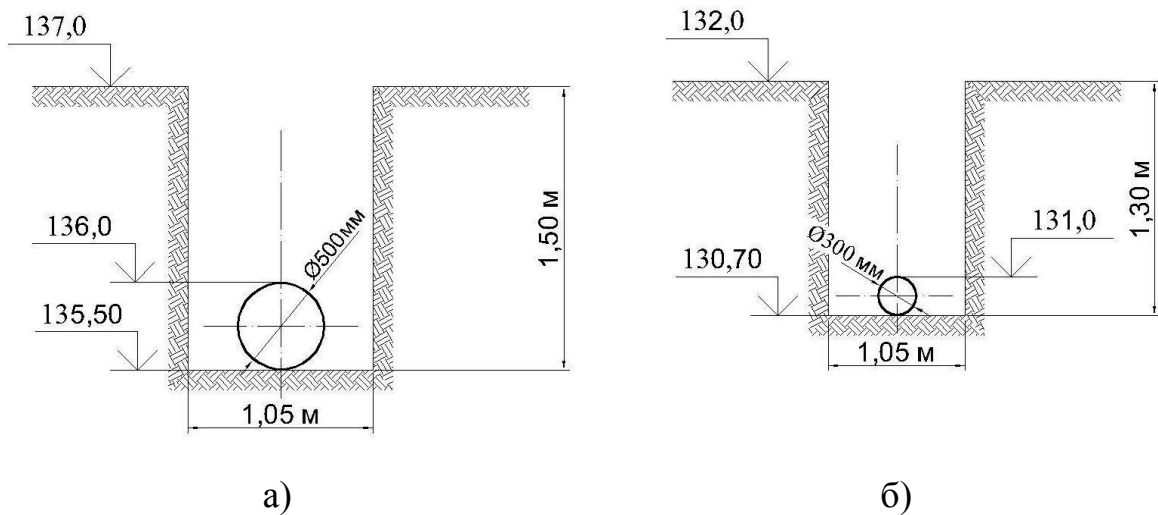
Поперечний переріз траншеї: а) трубопровід 1-Кр1 на пікеті ПК 4+40; б) трубопровід 1-Кр1.5 на ПК 21+00
